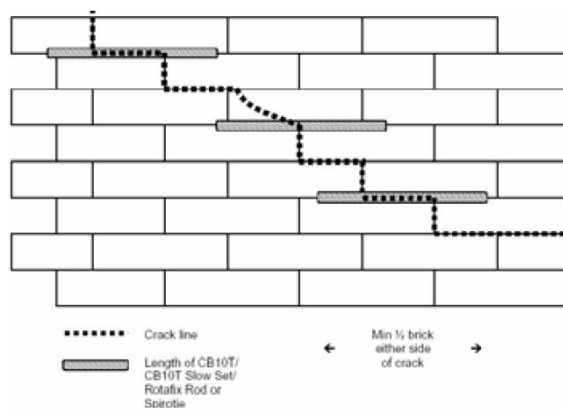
Esquema da fissuração e respetiva intervenção de reforço
